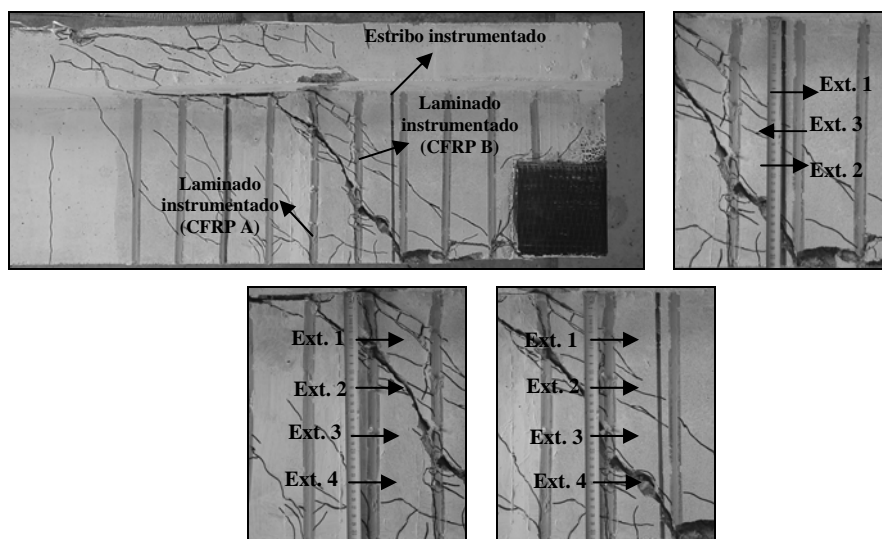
Localização dos extensómetros no laminado e estribo instrumentados da viga 2S-10LV-B.
